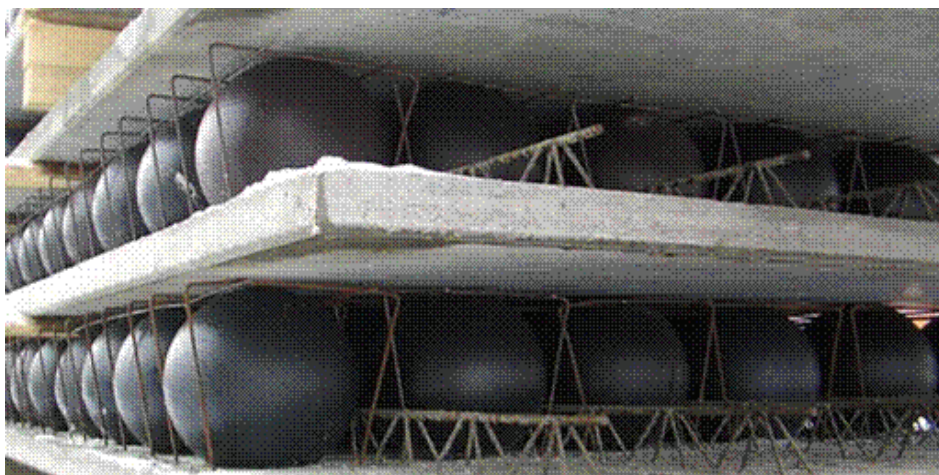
Сборно-монолитное перекрытие со скрытыми пустотами.
